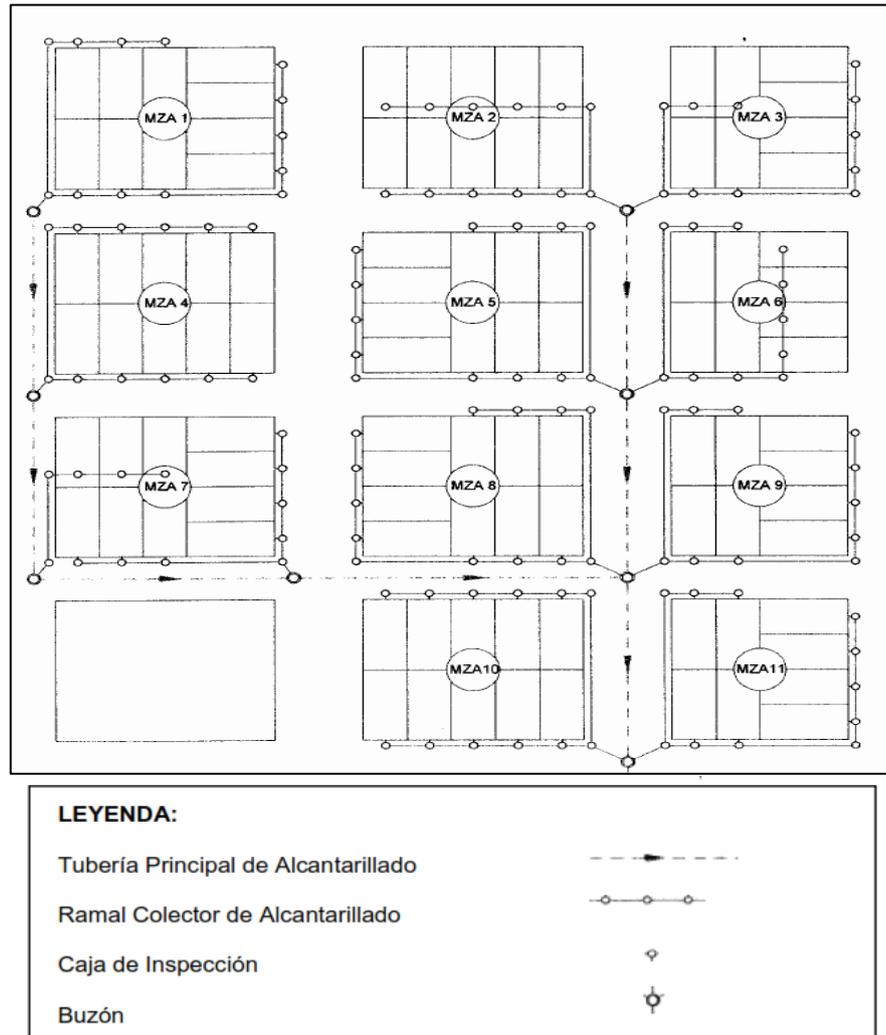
Esquema de distribución del sistema de red de alcantarillado.
